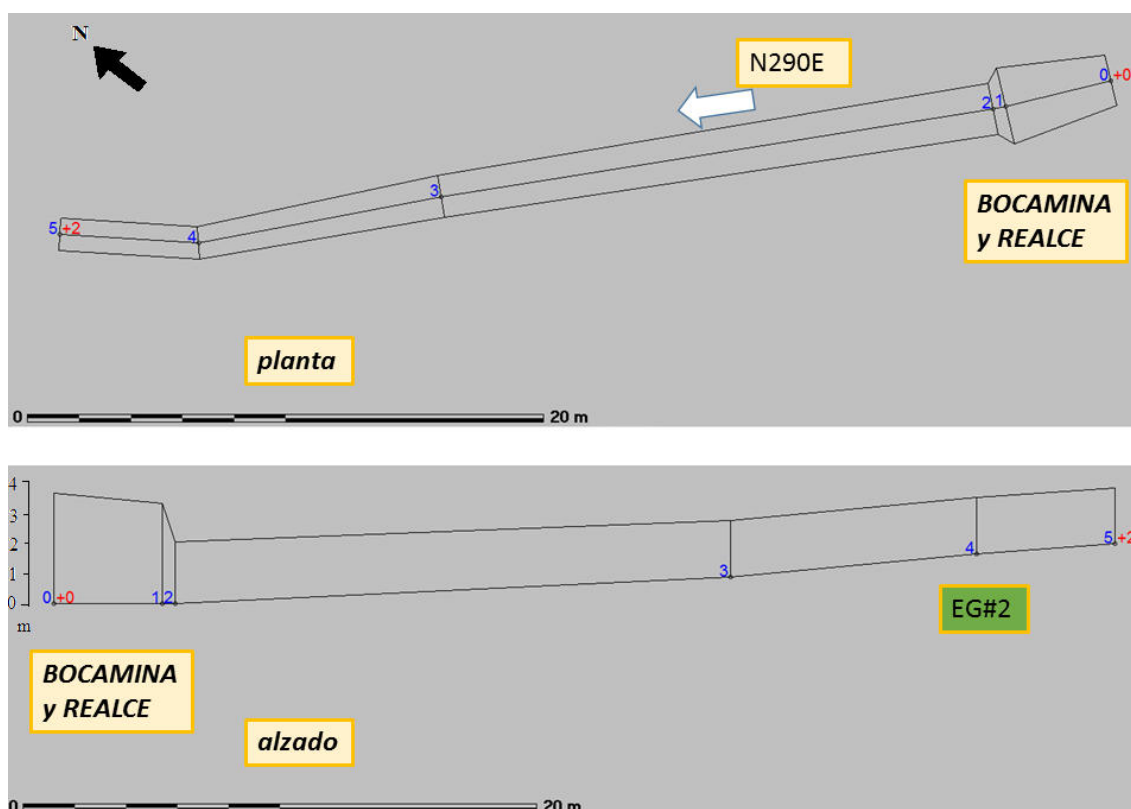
Planta con la dirección de la galería (N290°E) y alzado con la situación de la estación geomecánica de la galería de la Vueltona.
